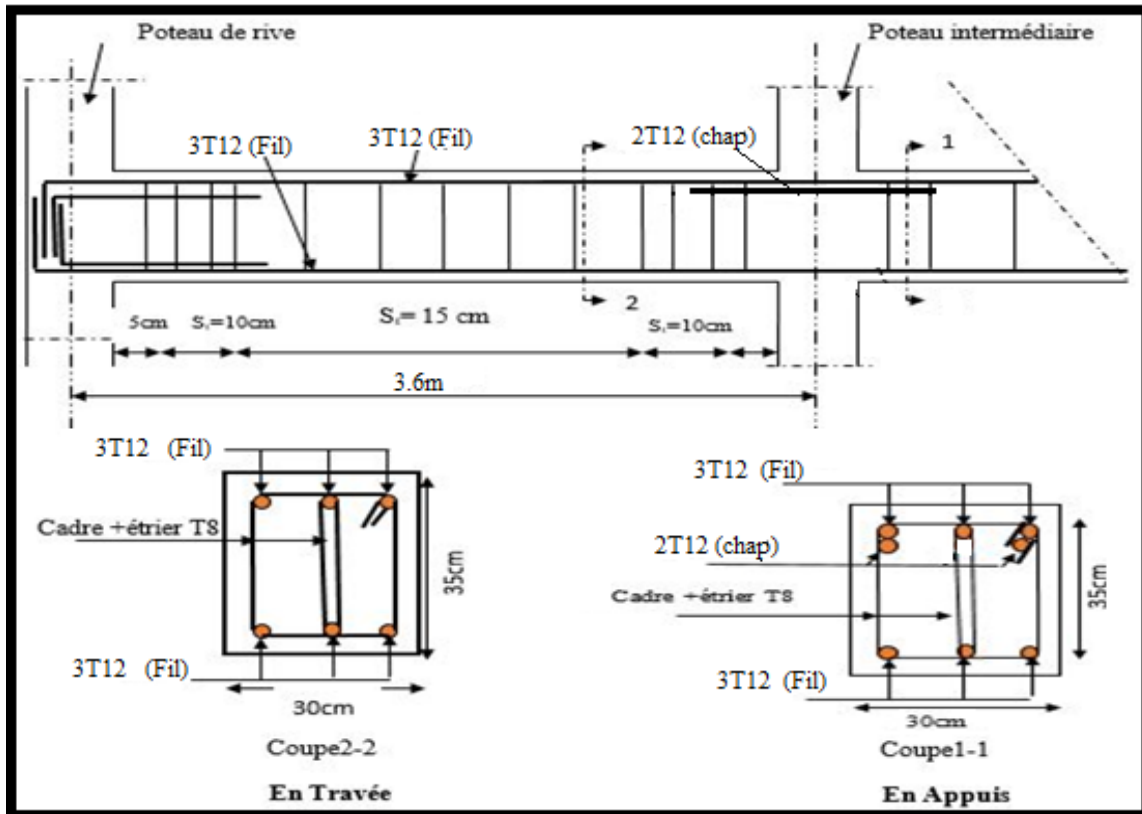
schéma de ferrailage des poutres secondaires nonassociées au voile.
